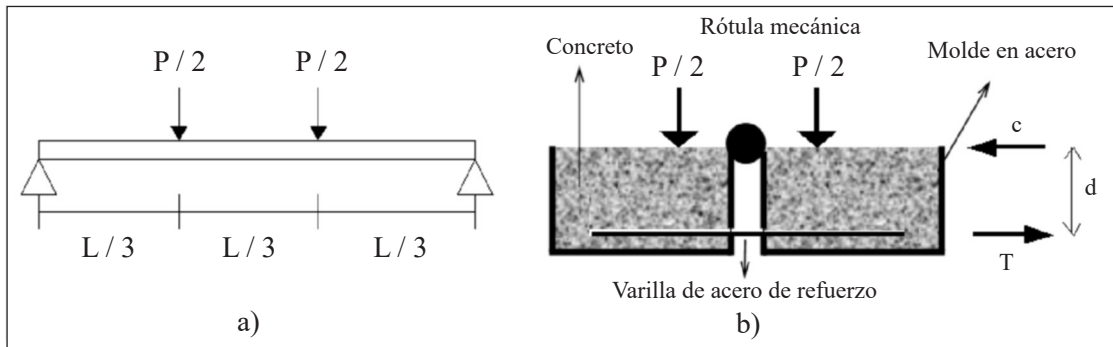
a) Viga simplemente apoyada con cargas en los tercios de su longitud. b) Dispositivo de ensayo y equilibrio de fuerzas internas en la zona central de la viga.
